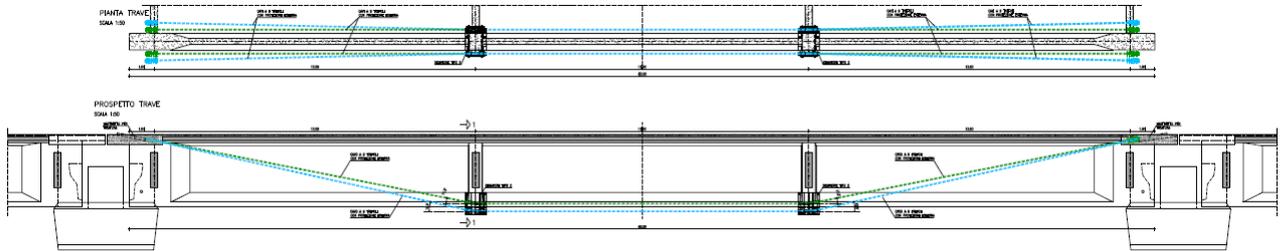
Interventi di consolidamento delle travi con 1+1 cavi di precompressione
